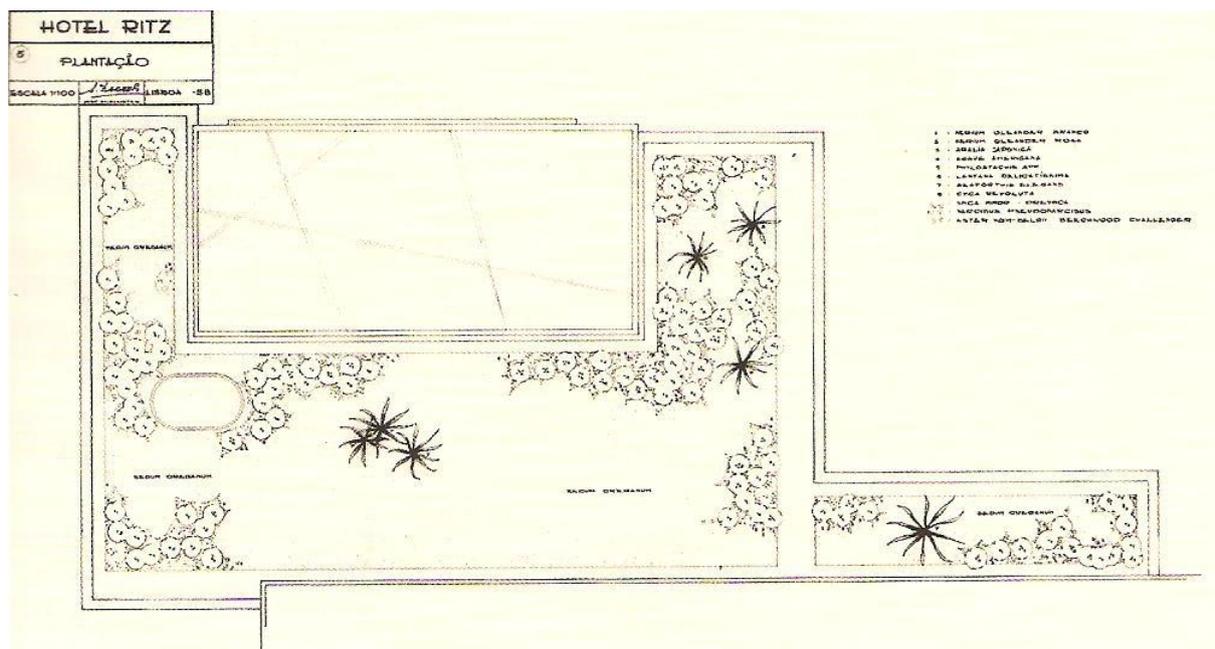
Hotel Ritz, em Lisboa: Plano de plantação. 1958.
